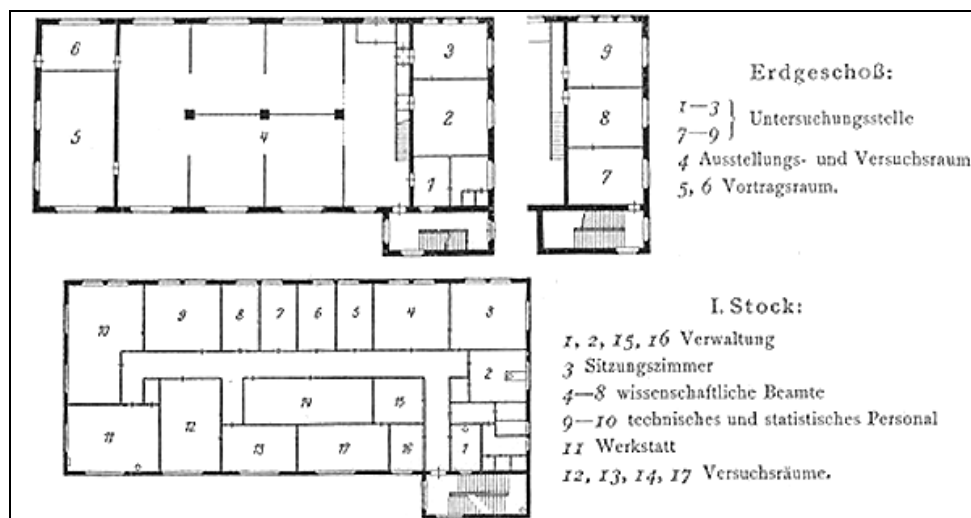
Grundriss der Psytev Berlin 1927¹¹⁸⁸
